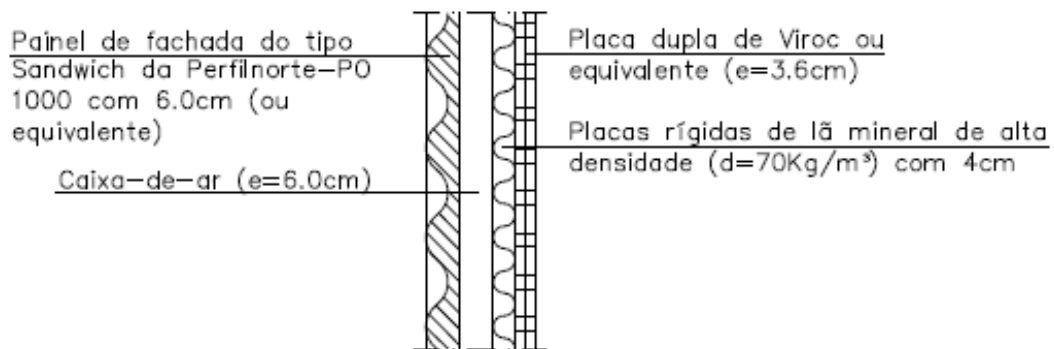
Pormenor construtivo da parede exterior do piso recuado (Projeto de CT)
